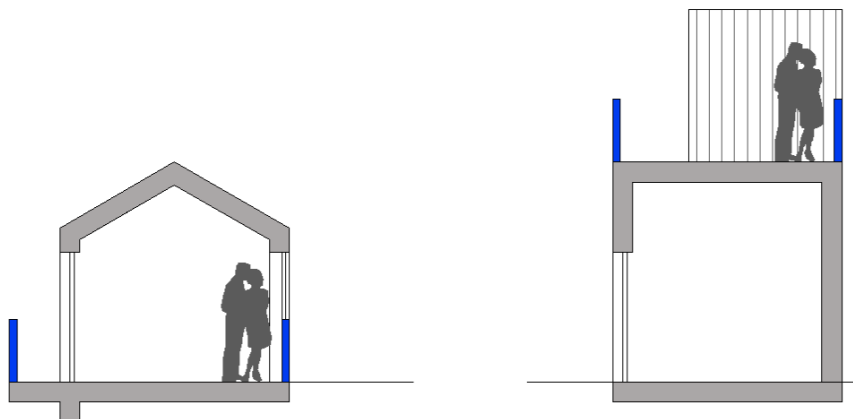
Protezione contro il rischio di caduta assicurata mediante impianti fotovoltaici: balconi, parapetti ecc.
